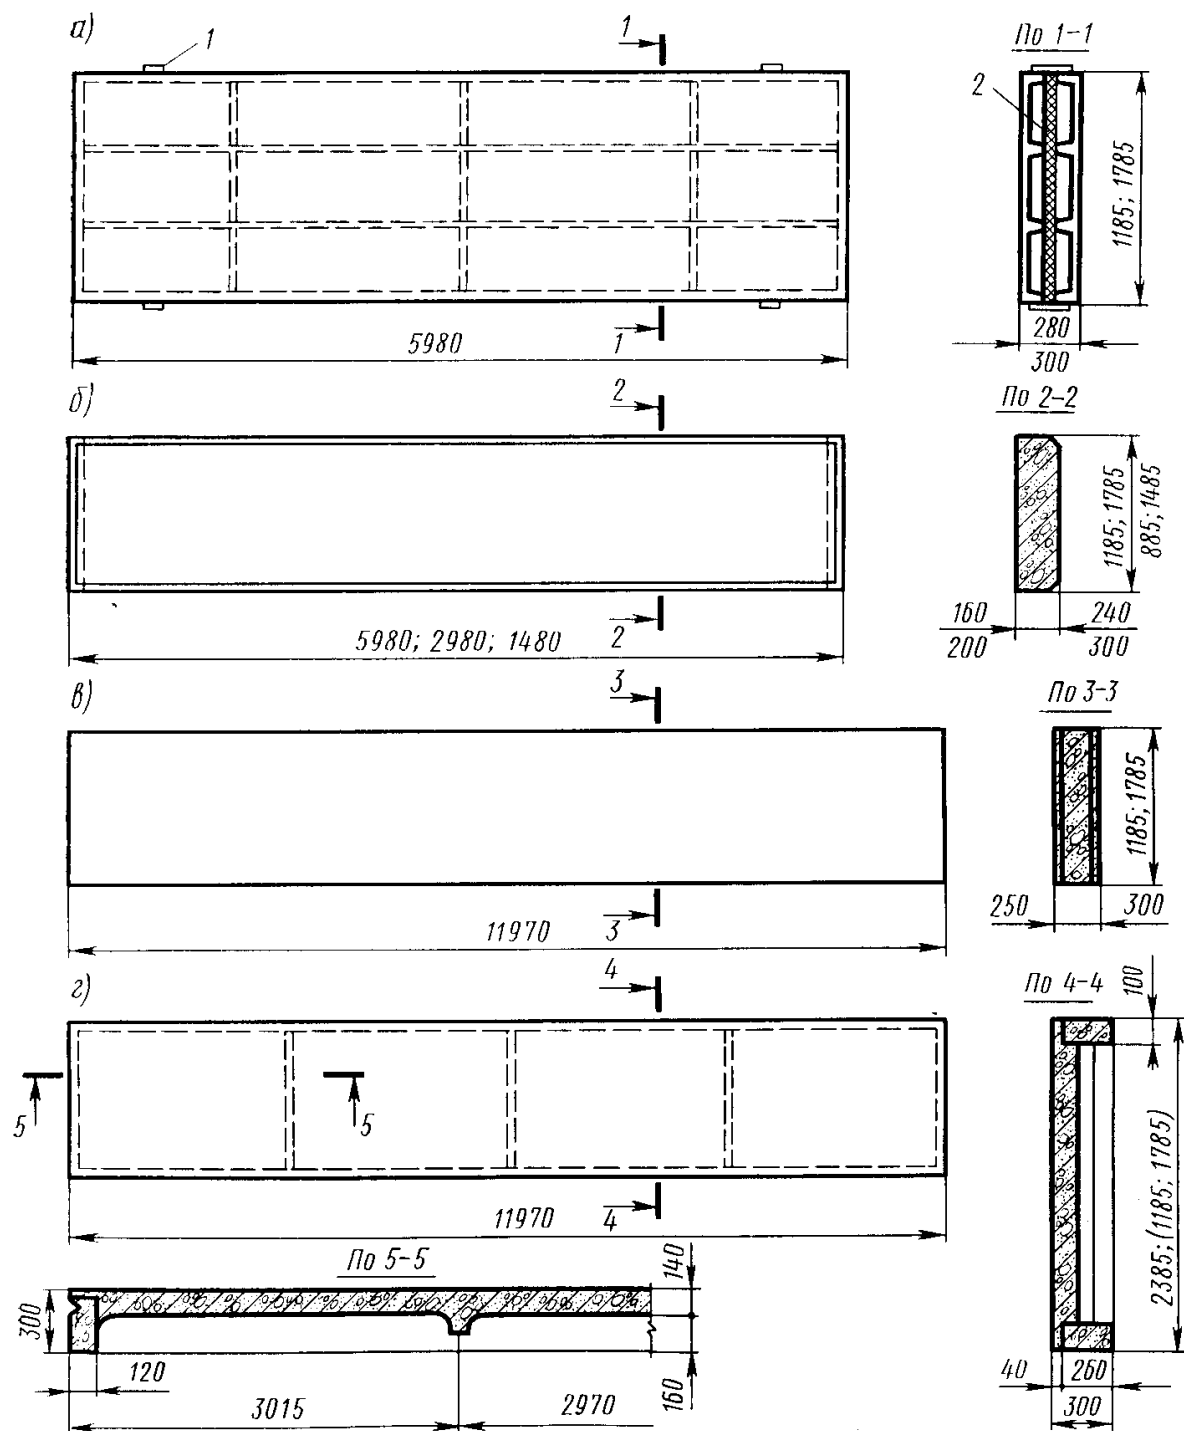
Схемы панелей для стін опалюваних будівель:
